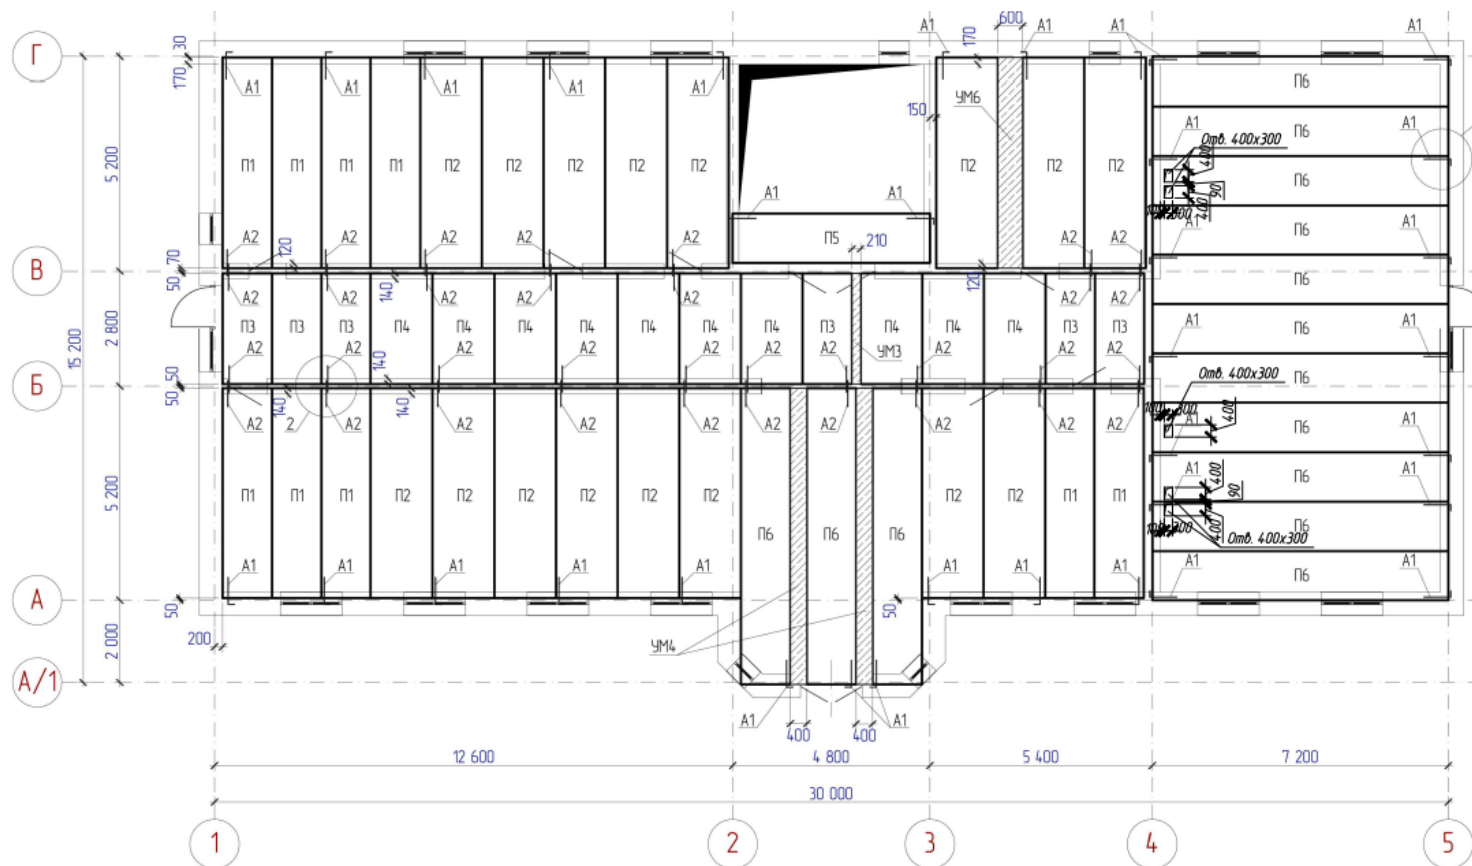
Схема расположения панелей перекрытия первого этажа
